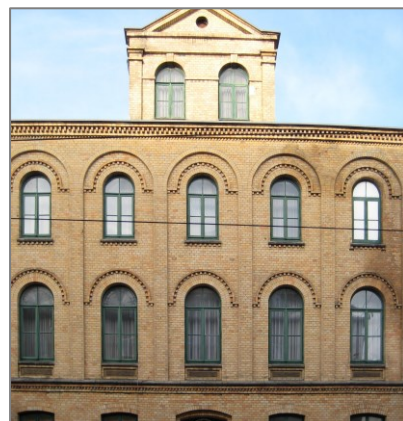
Rundbögen 34 Davenstedter Straße 4, 34 Falkenstraße 15
